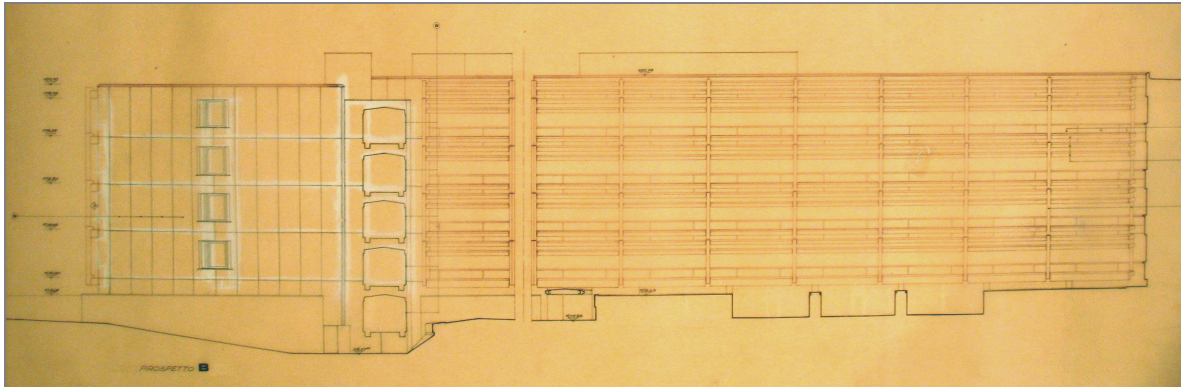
prospetto interno B (fonte CSAC – stralcio tav. 56, archivio n. 384-6)
